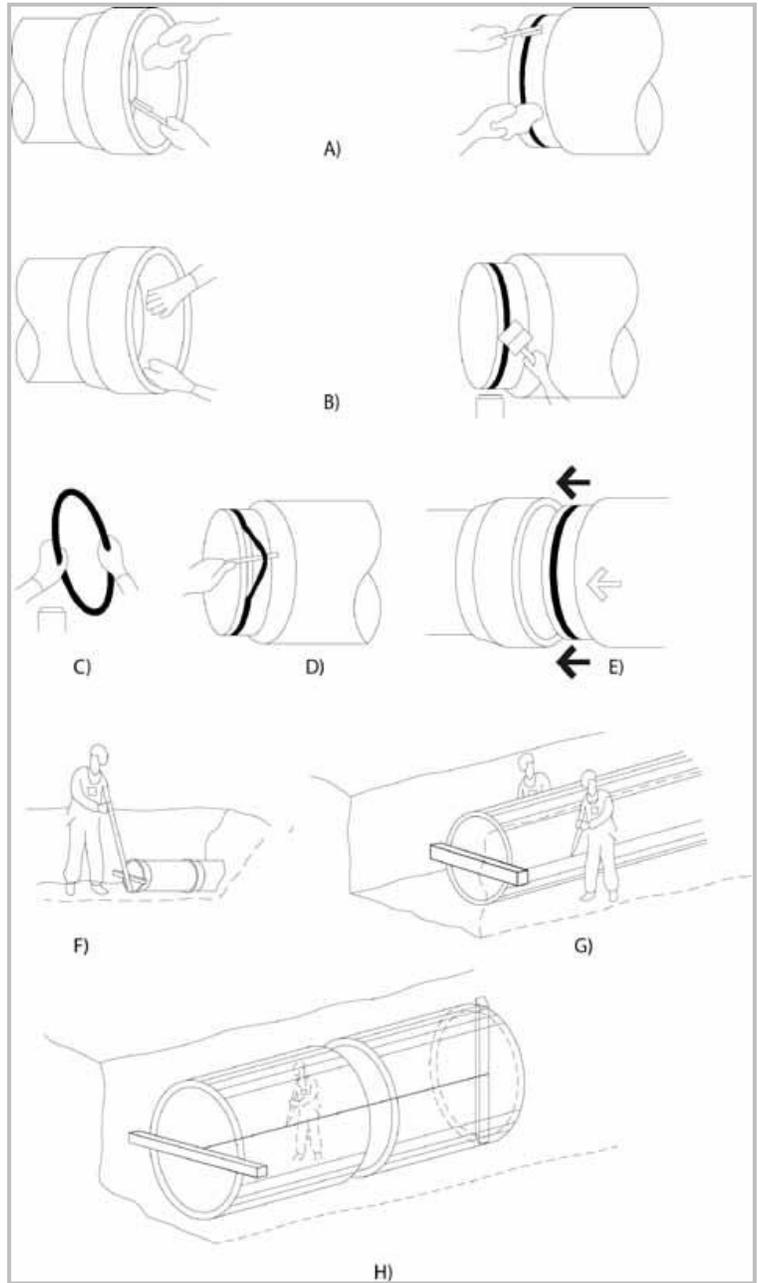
Instalación de tubería de concreto simple o reforzado
